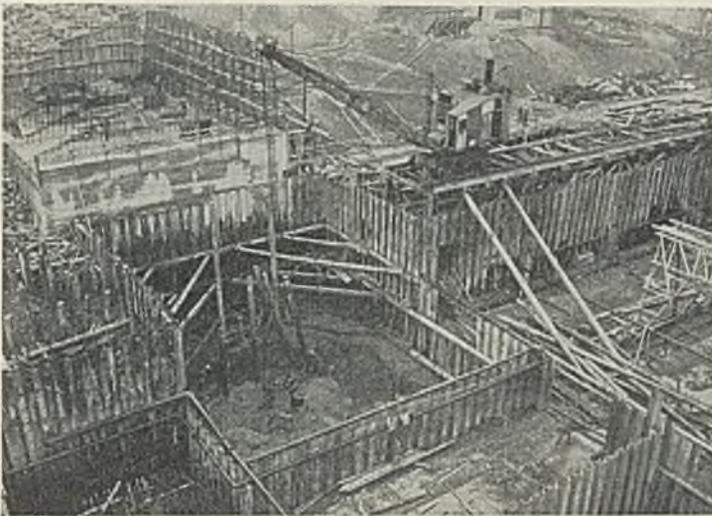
Ausschachtung und Aussteifung der Baugrube des südlichen Torpfeilers am Außenhaupt.
